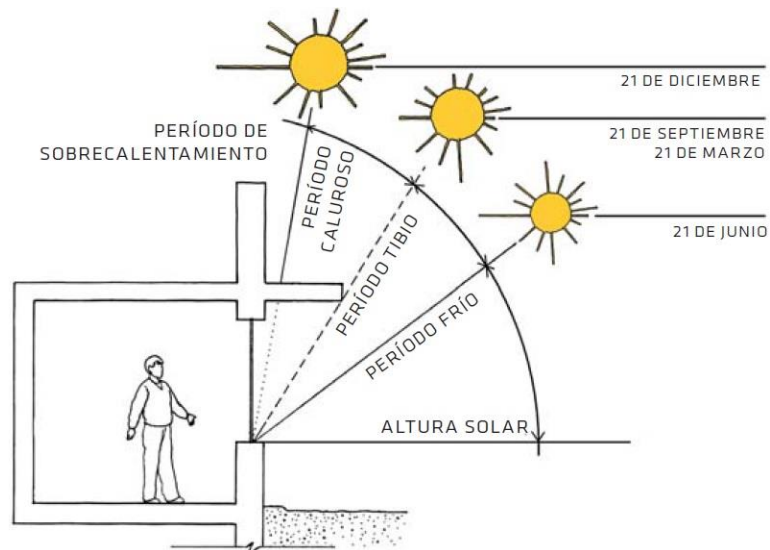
Esquema alero en disposición norte. [Imagen extraída de: Lavigne Pierre, 2003]
